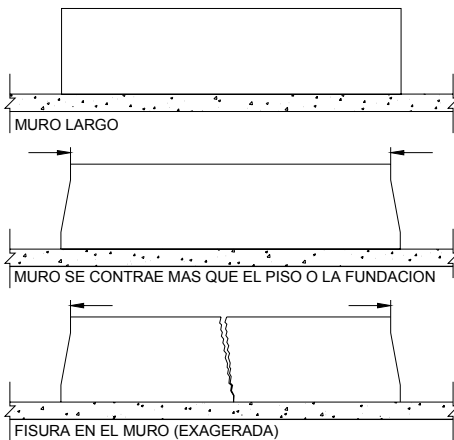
Fisuras de un muro largo debido a la Contracción
